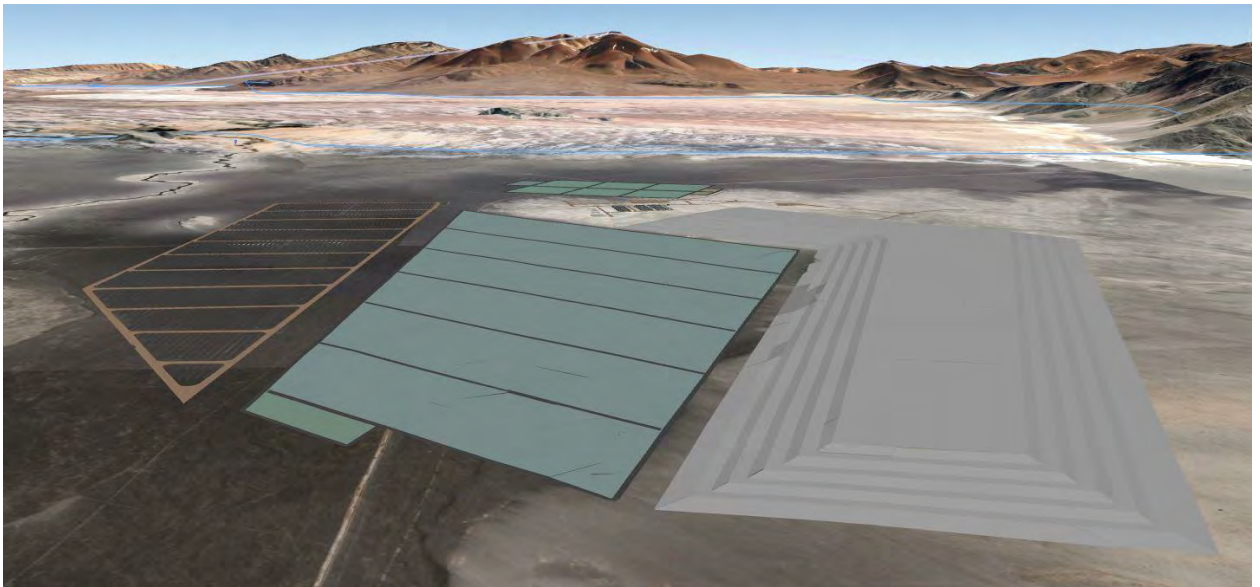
Vista de sur a norte las piletas de evaporación, planta de procesamiento y de los acopios de sales de cosecha.
